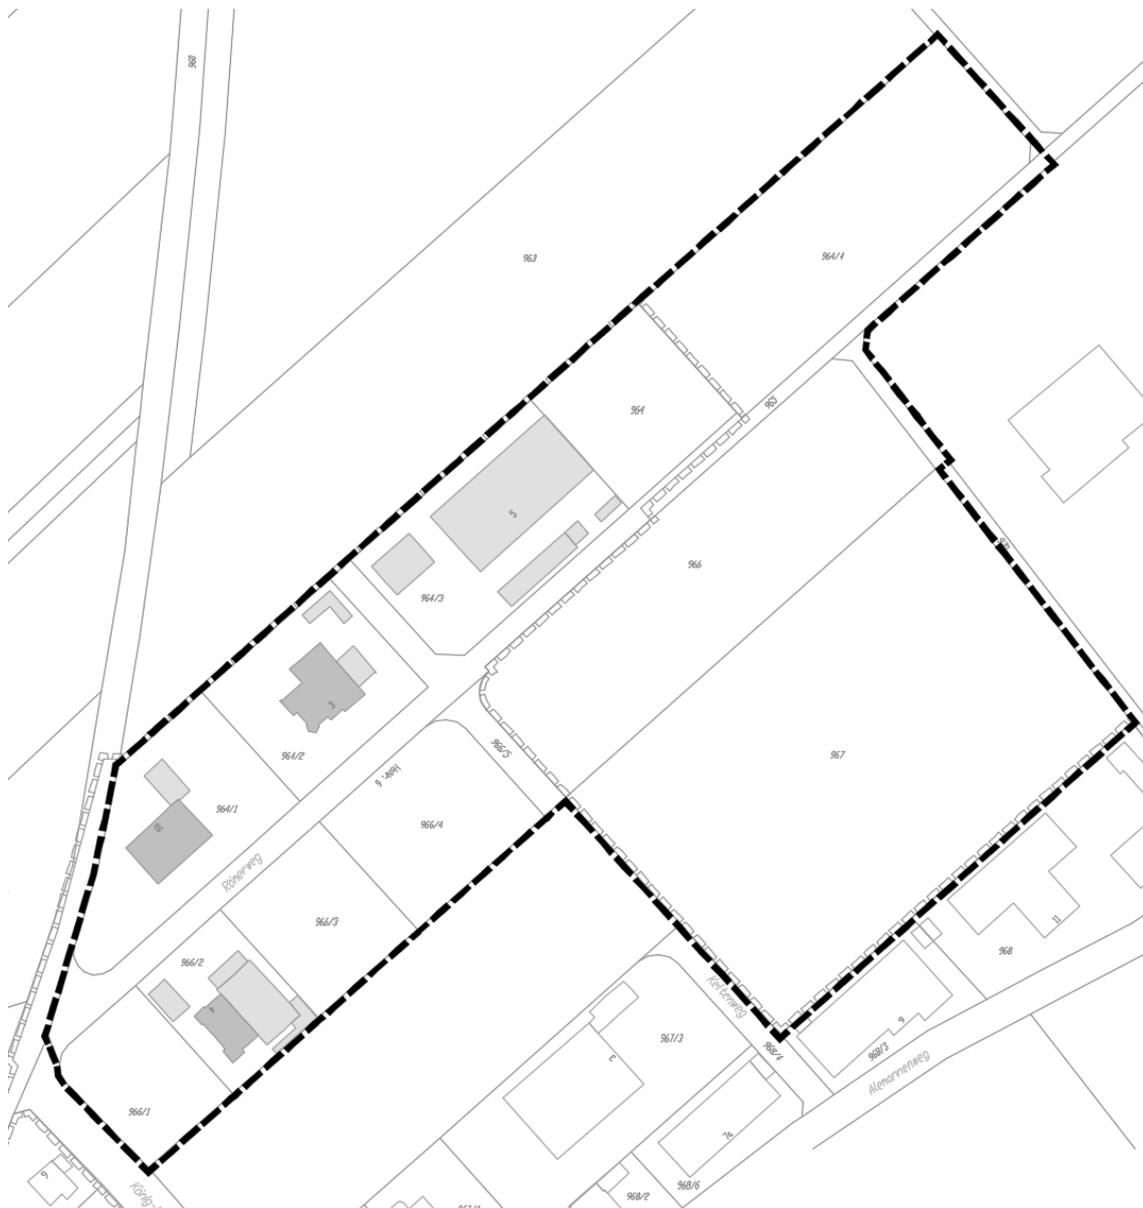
Lageplan des Geltungsbereiches, unmaßstäblich
